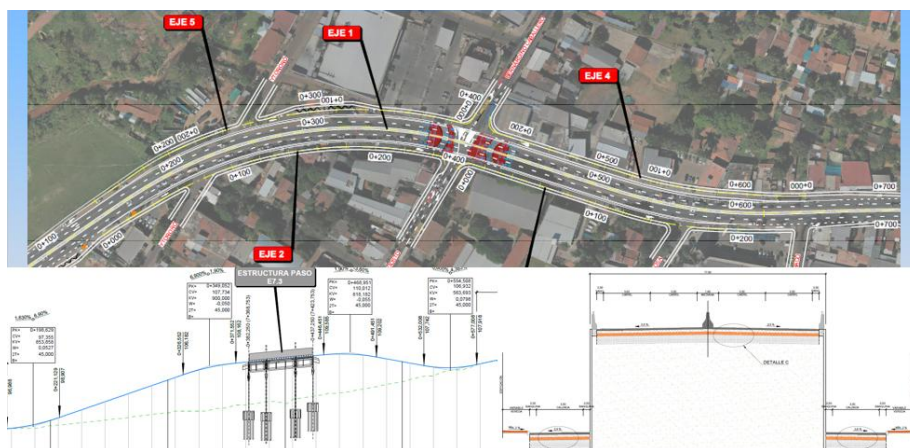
Intersección con Avda. Bernardino Caballero – Implantación en Planta y perfil estructural
